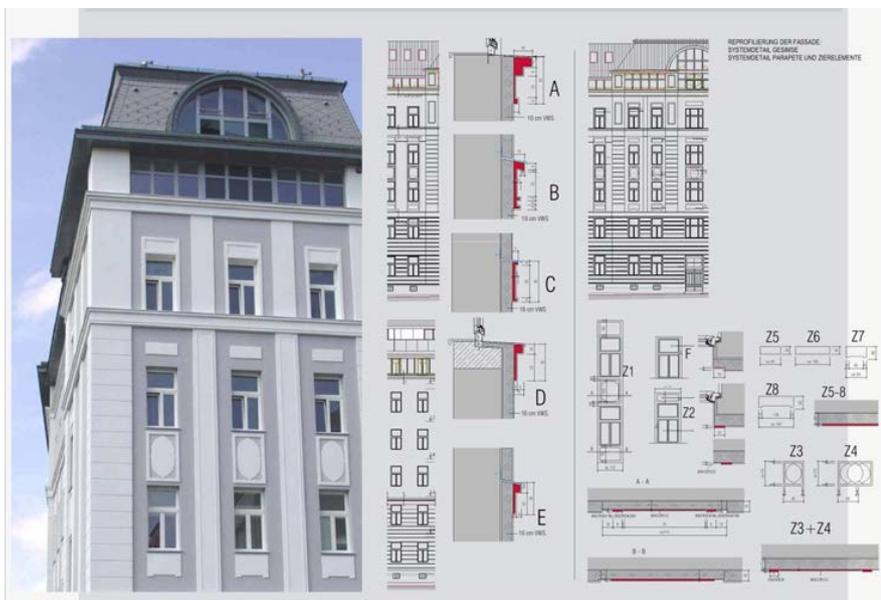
Projekt Robert Blumgasse 1+3, Zier und Dekordetails
